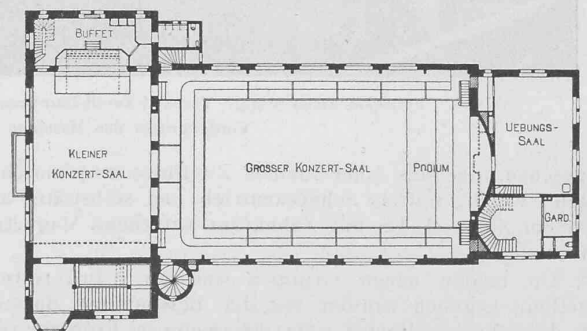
Saalbau. — Grundriss vom Obergeschoss. — 1 : 600.
